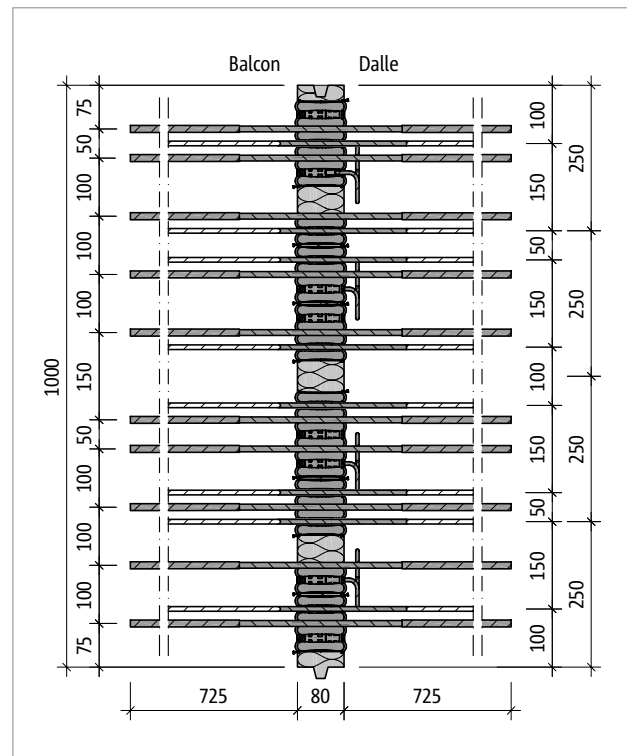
Schöck Isokorb® T type K-T-M7-V1 : plan de base du produit
